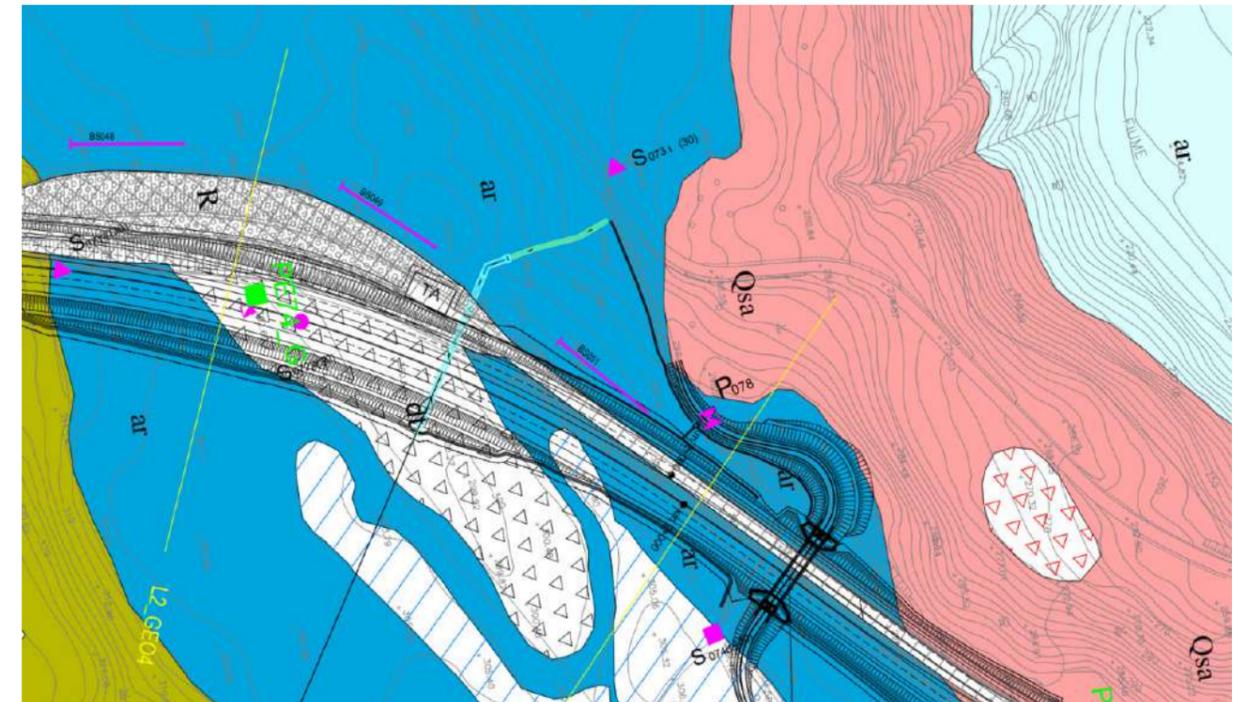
stralcio carta geologica, sistemazione idraulica al km 1+900
